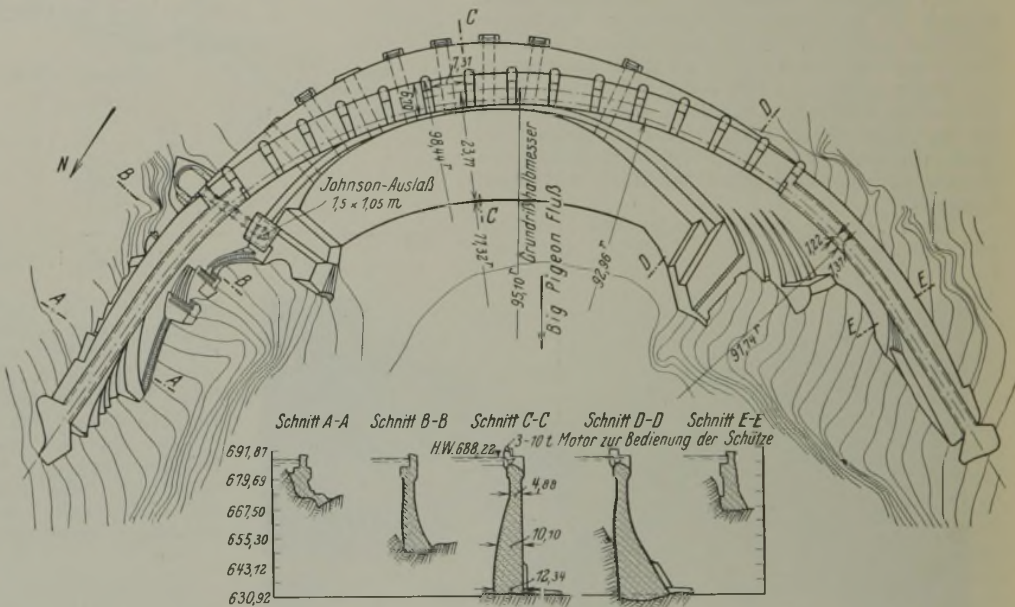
Grundriß und Querschnitte der Waterville-Staumauer.
